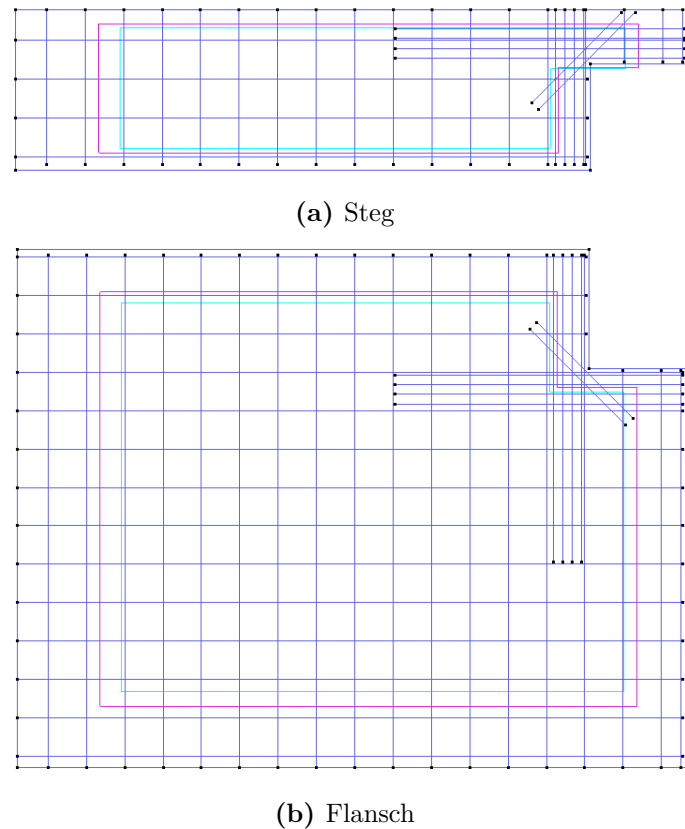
1D-Bewehrung Halbfertigteile inkl. Zulagen
